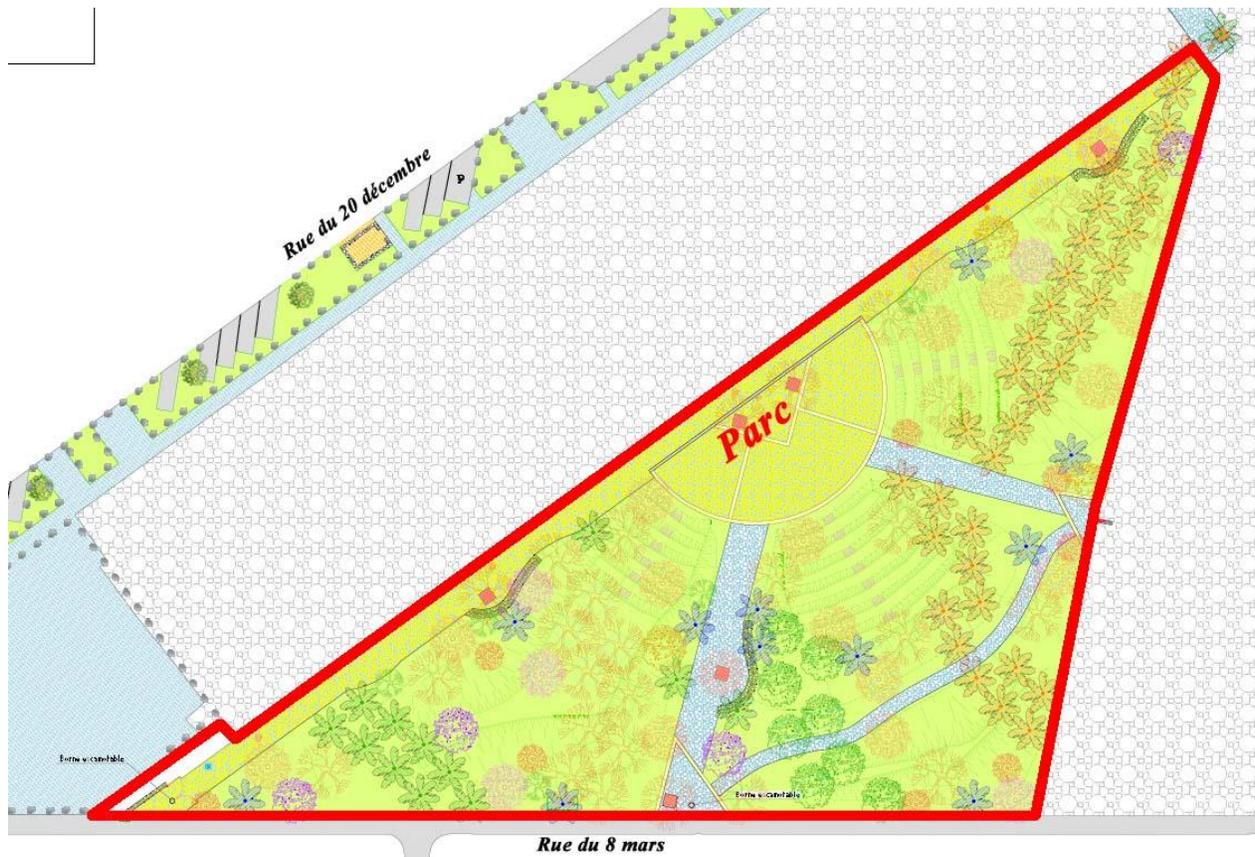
extrait plan de récolement Plantations - réalisé par EVE
